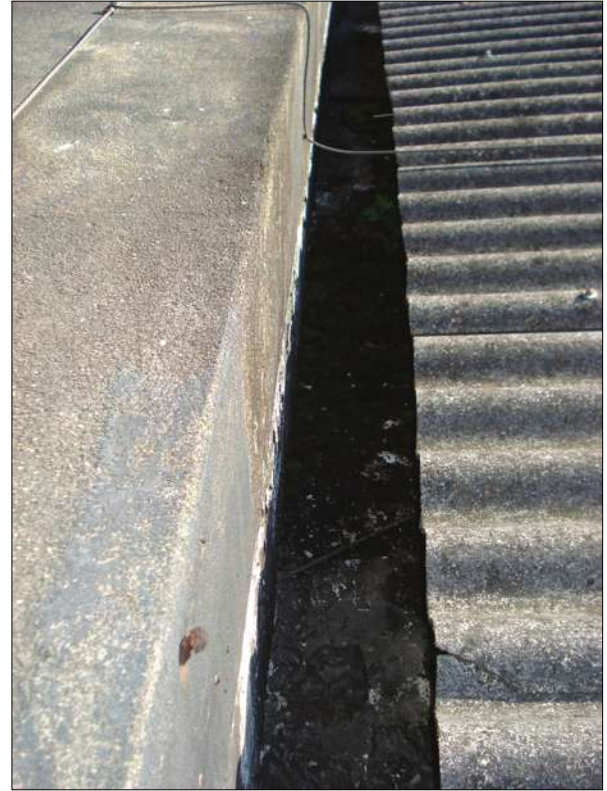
Outra vista da calha de captação de águas pluviais
